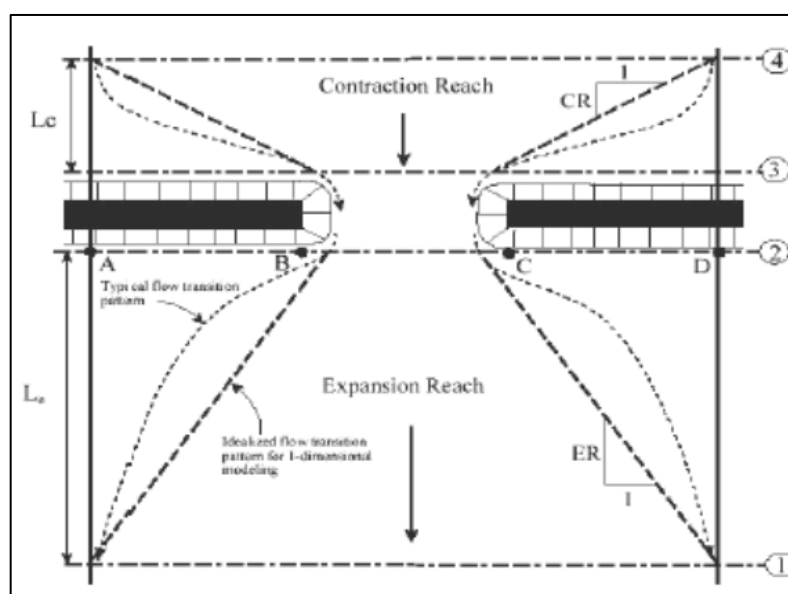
Schema di un restringimento della sezione di deflusso provocato dalla presenza in alveo delle spalle di un ponte (Fonte: Fugazza, 2011).
